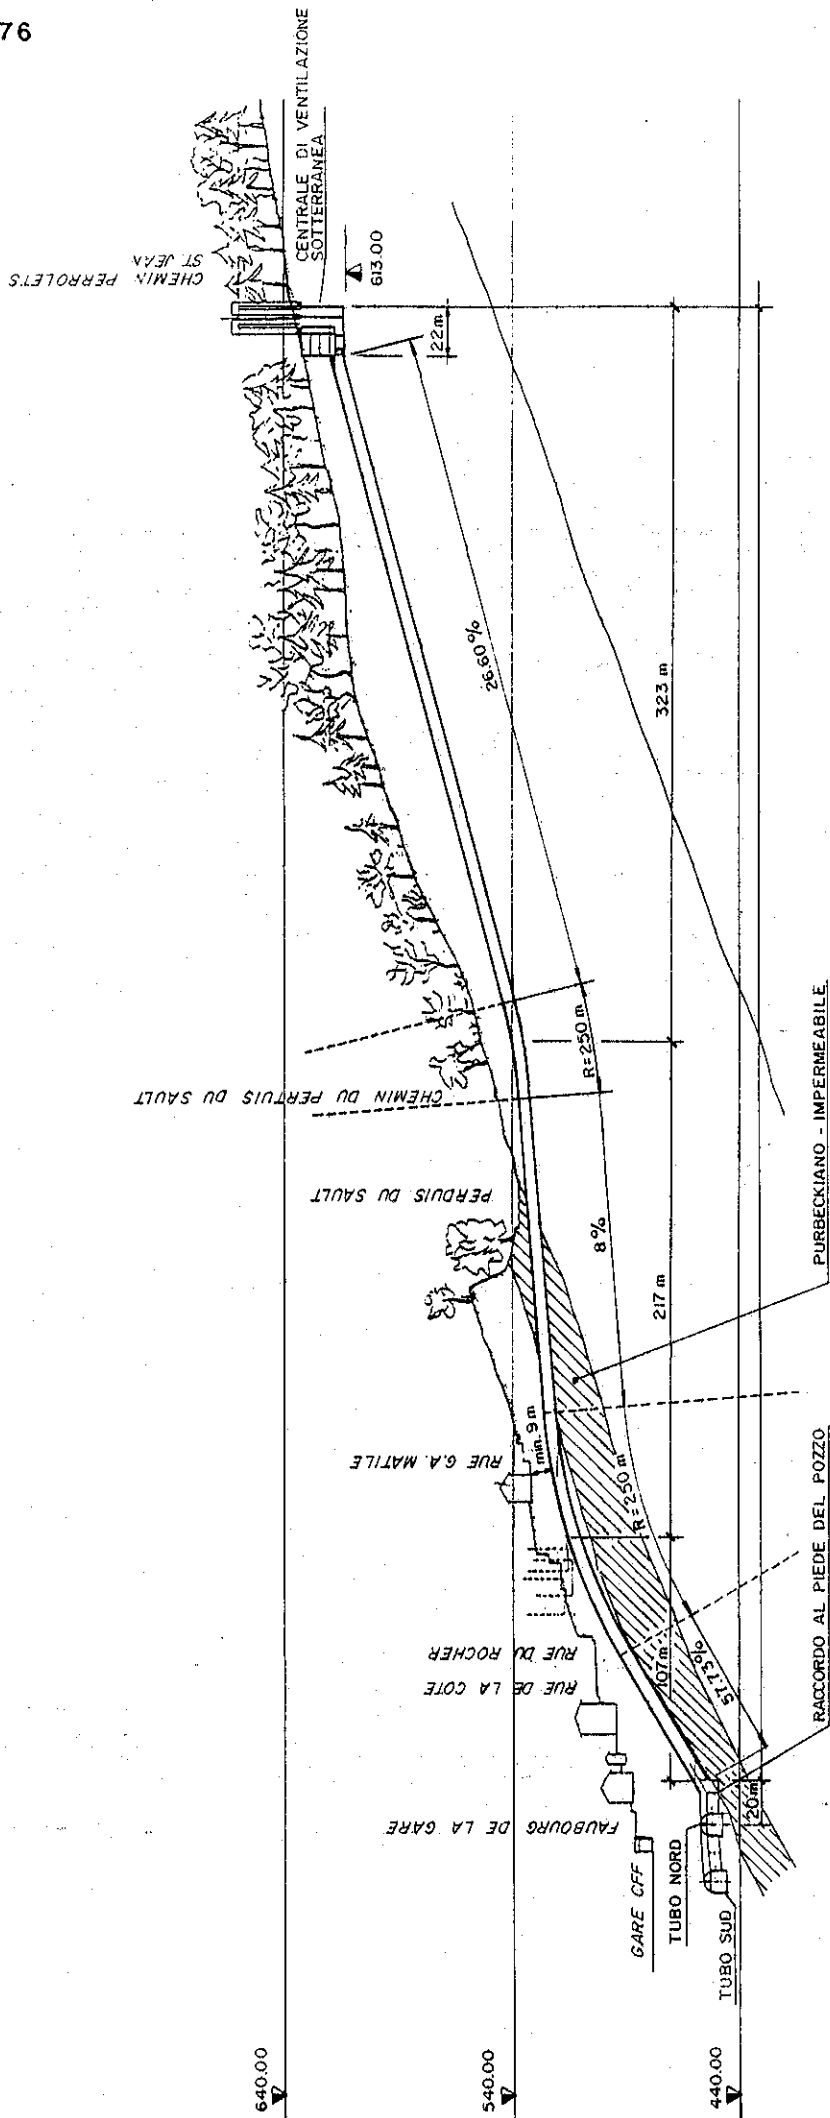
Profilo longitudinale del pozzo di ventilazione della galleria autostradale Est di Neuchâtel
